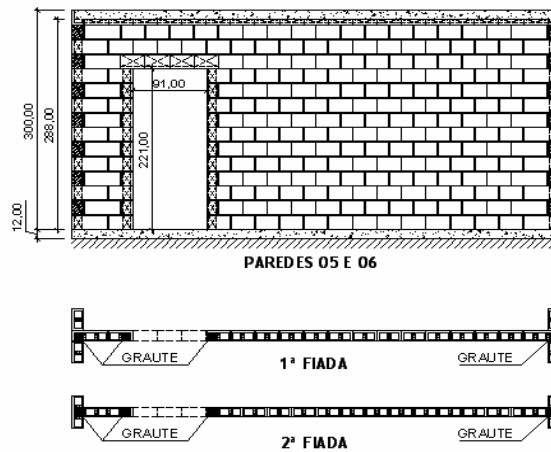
Paredes 05 e 06 – Detalhe da 1ª e 2ª fiadas e elevação.
